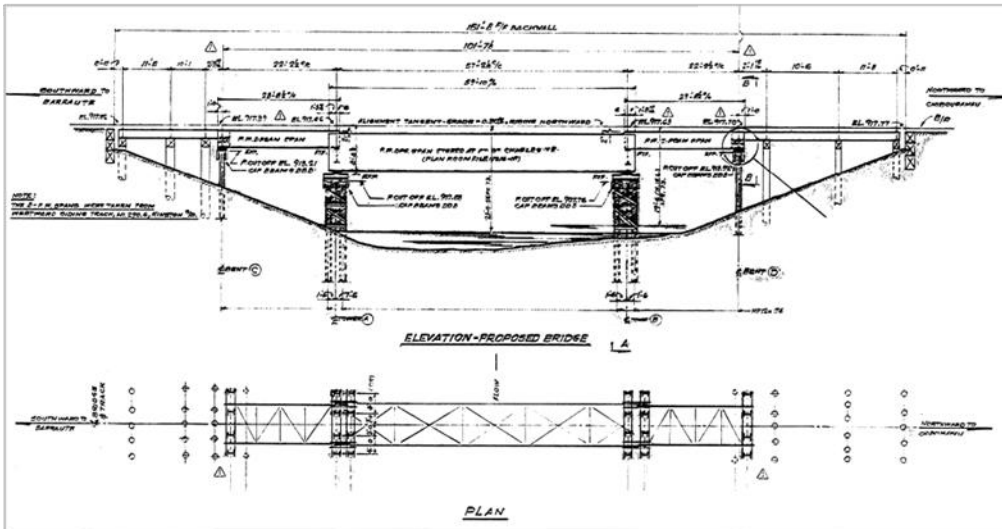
Vue en plan et en élévation du pont PM 101.80 Chapais
